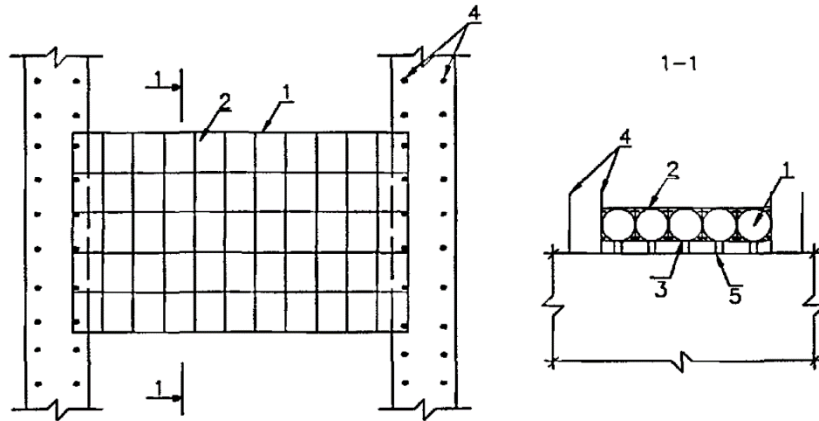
Схема виконання робіт при бетонуванні пролітних конструкцій: 1 - пневмомодуль, 2 - верхня арматурна сітка, 3 - нижня арматурна сітка, 4 - випуски арматури з стіни, 5 – підкладка
